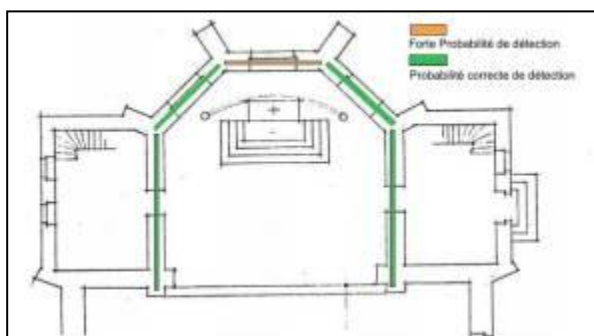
Zones de probabilité d'y trouver la pierre fondatrice
